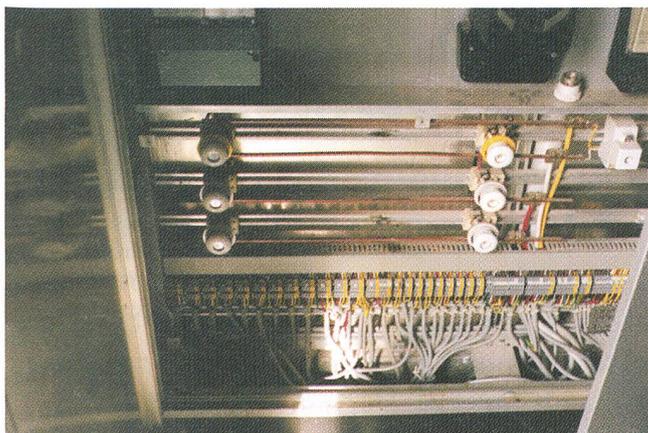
Recouvrement retiré, bornes et pièces sous tension non-recouvertes
